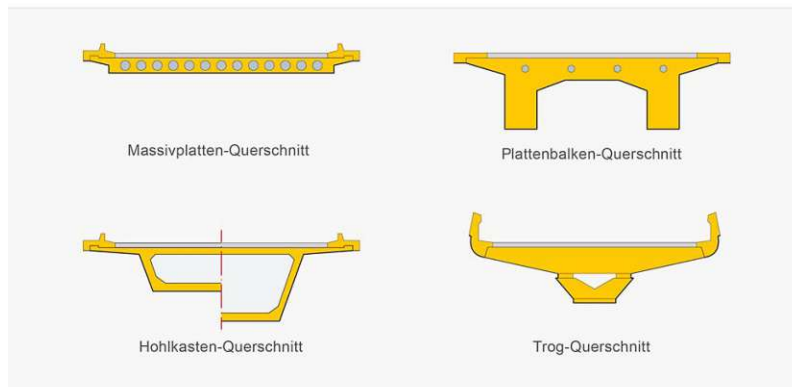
Querschnittsformen von Beton-Plattenbrücken [71]
